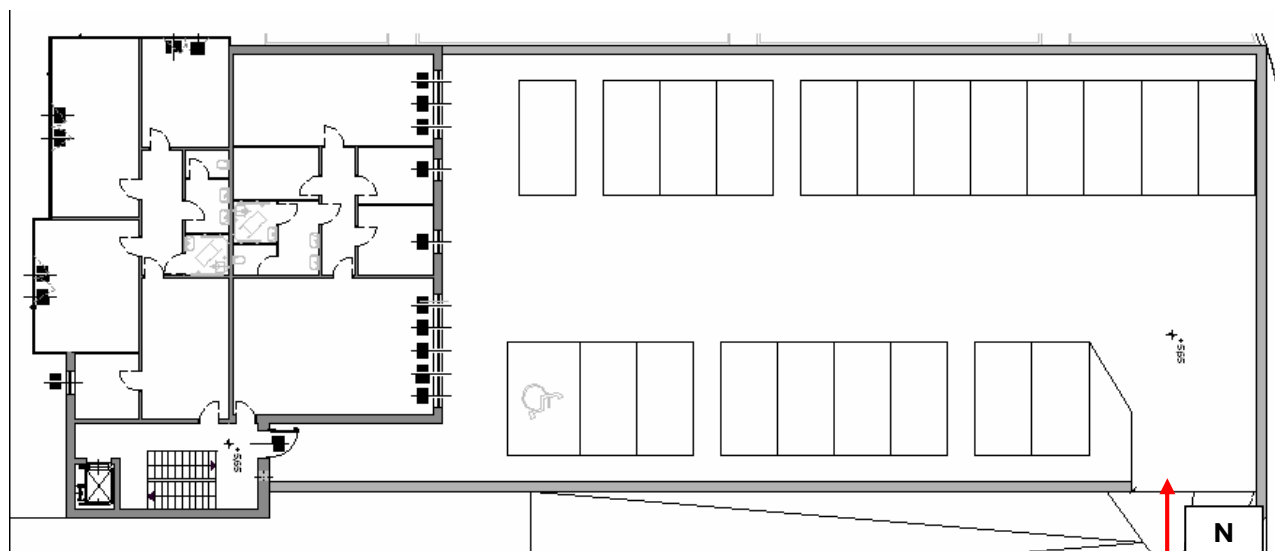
Progetto architettonico: planimetria P1 lotto n. 3
